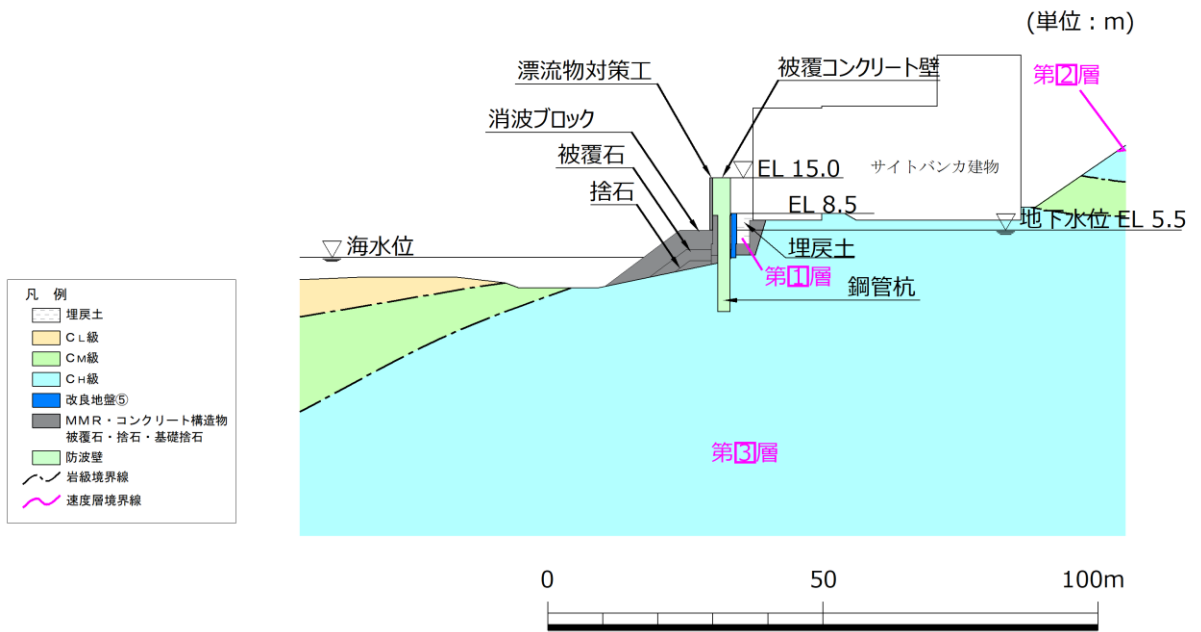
防波壁（多重鋼管杭式擁壁）の横断面図（⑤-⑤断面）
